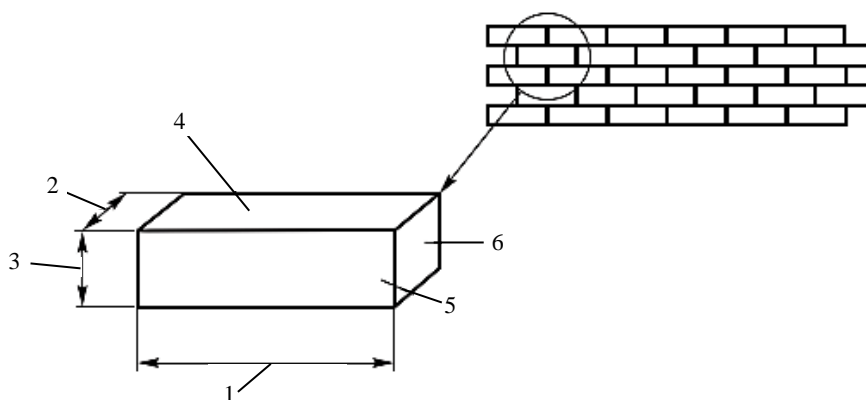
Размеры и поверхности кирпича: 1 — длина; 2 — ширина; 3 — высота; 4 — опорная поверхность; 5 — лицевая поверхность; 6 — торцевая/тычковая поверхность
